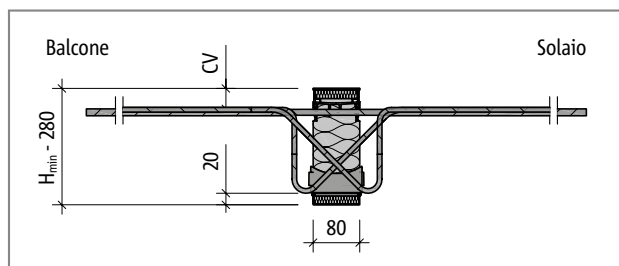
Schöck Isokorb® tipo K70M-VV – K110M-VV: Sezione dell'elemento
